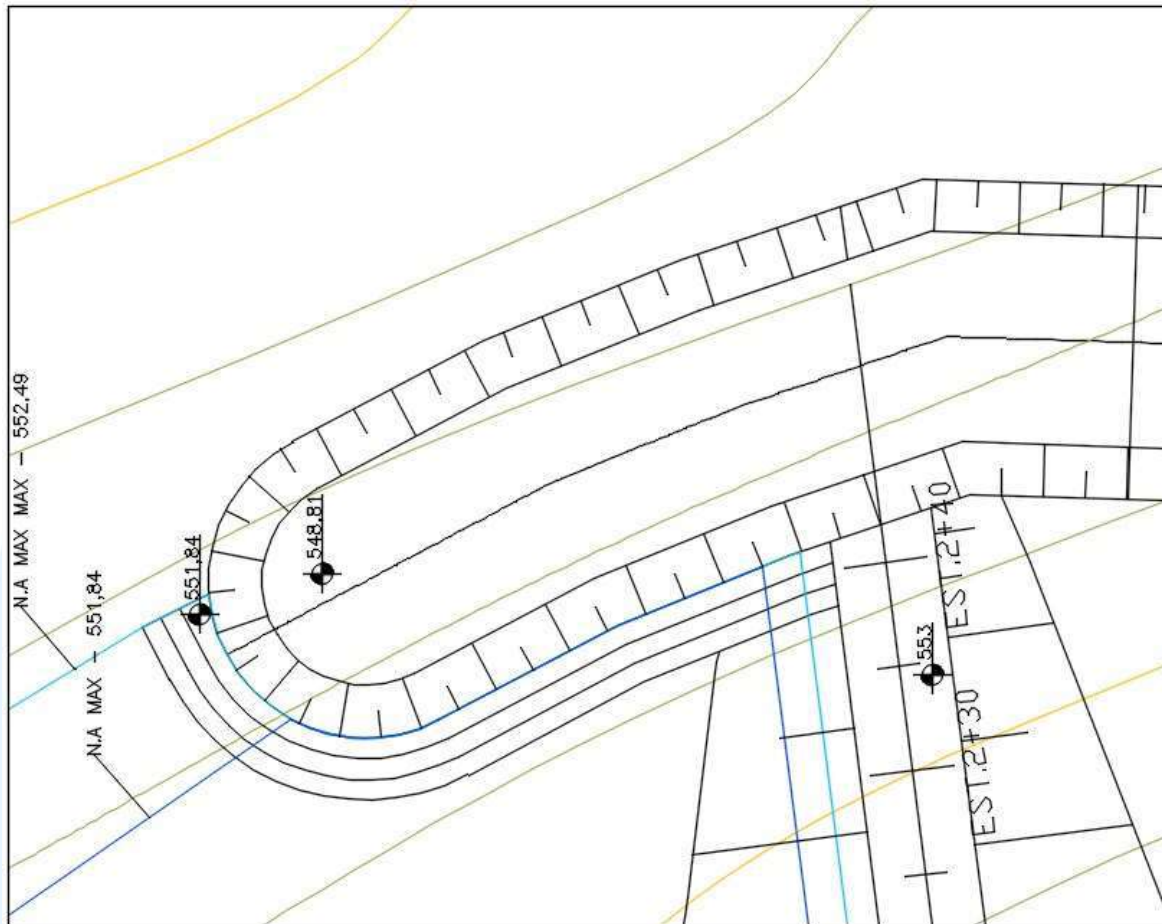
Planta do vertedor tipo tomada lateral (sem escala)
